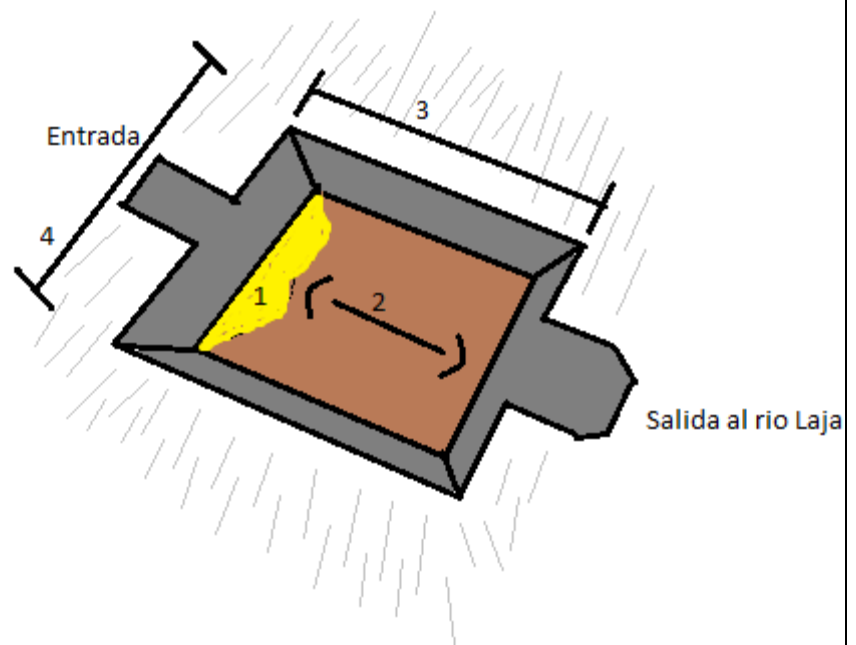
laguna de sedimentación. Fuente: Autor del proyecto
